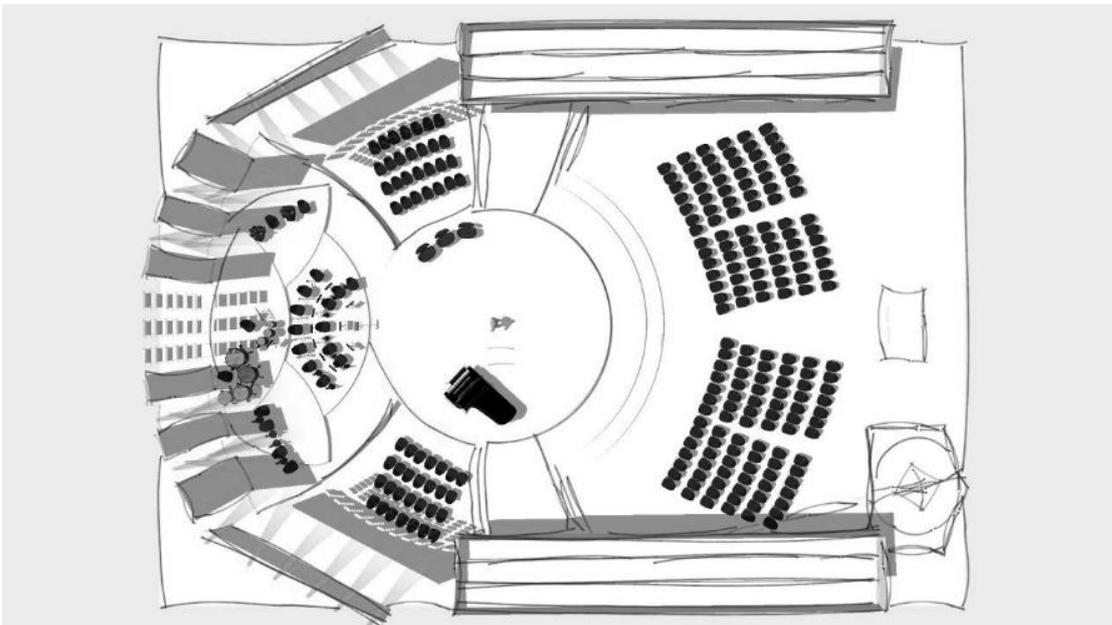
Planta baixa cenário. Fonte: arquivo pessoal.
